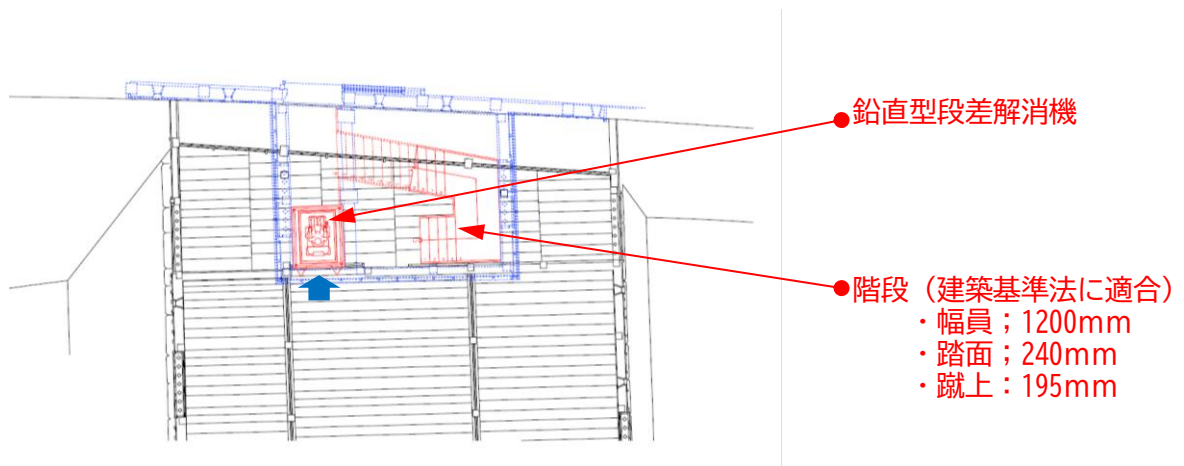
南廊下1階平面図 (南廊下便益施設案)
